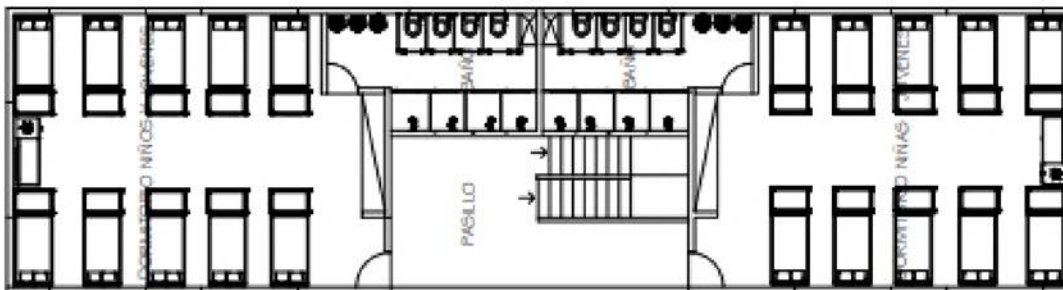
Edificio 5 - Planta amueblada – Creación Propia
